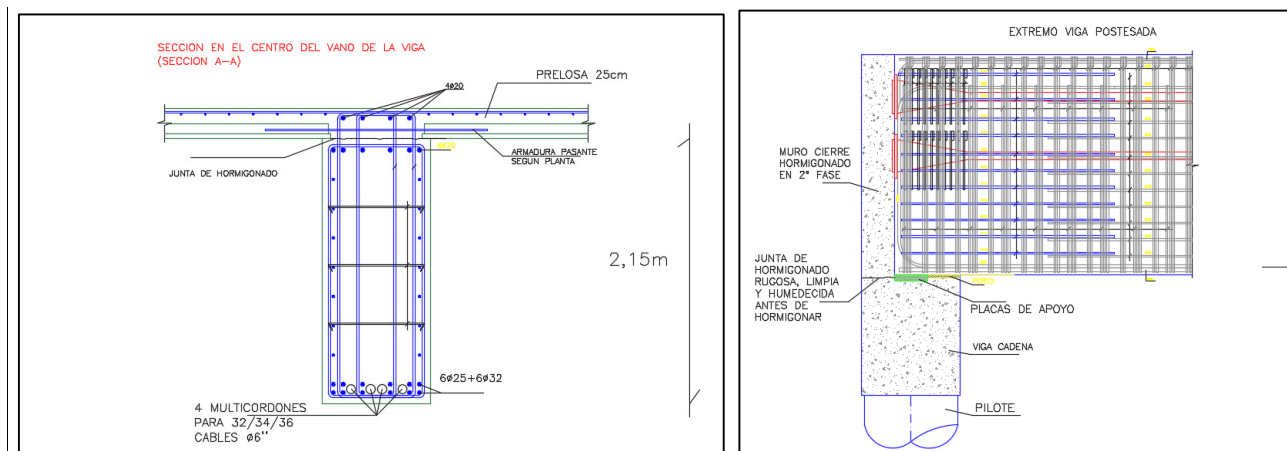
Sección de vigas y detalle apoyo en pantalla de pilotes.
